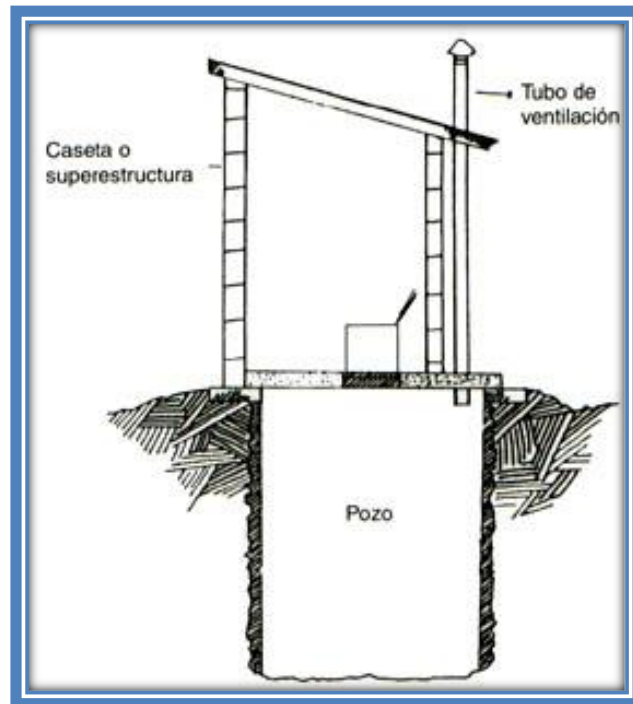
LETRINA DE HOYO MODIFICADO.
